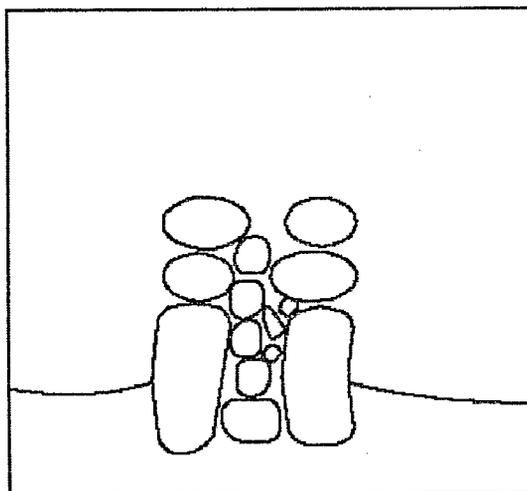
Detalle en perfil de la técnica constructiva de las estructuras 5, 4, 7 y el conjunto 1 de Ranchillos 2.
